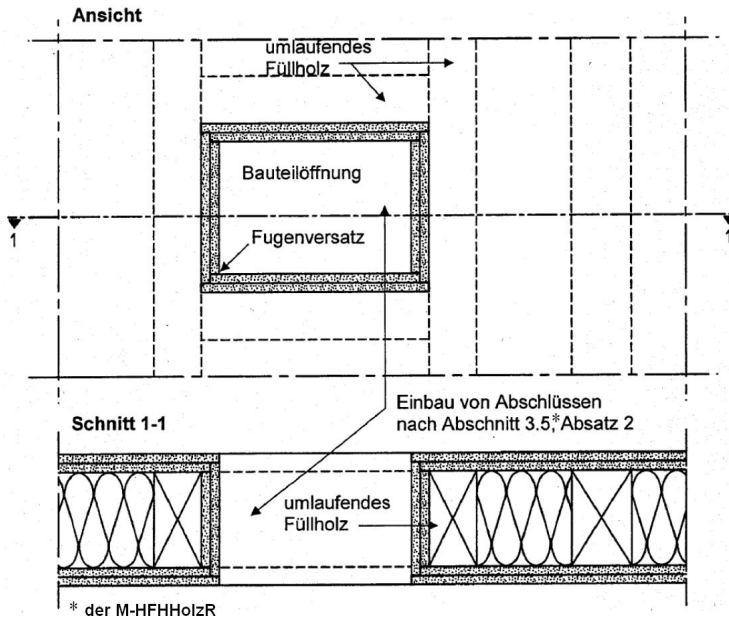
Führung der Brandschutzbekleidung in Öffnungslaibungen [36]
